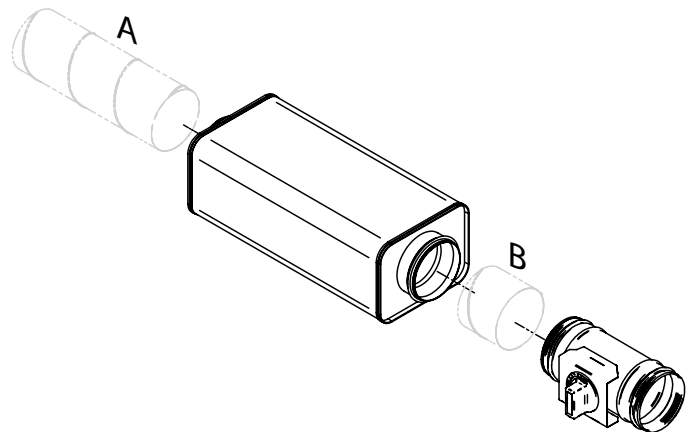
Kit d'air introduit, PARAGON T-SAK-CAV-125
